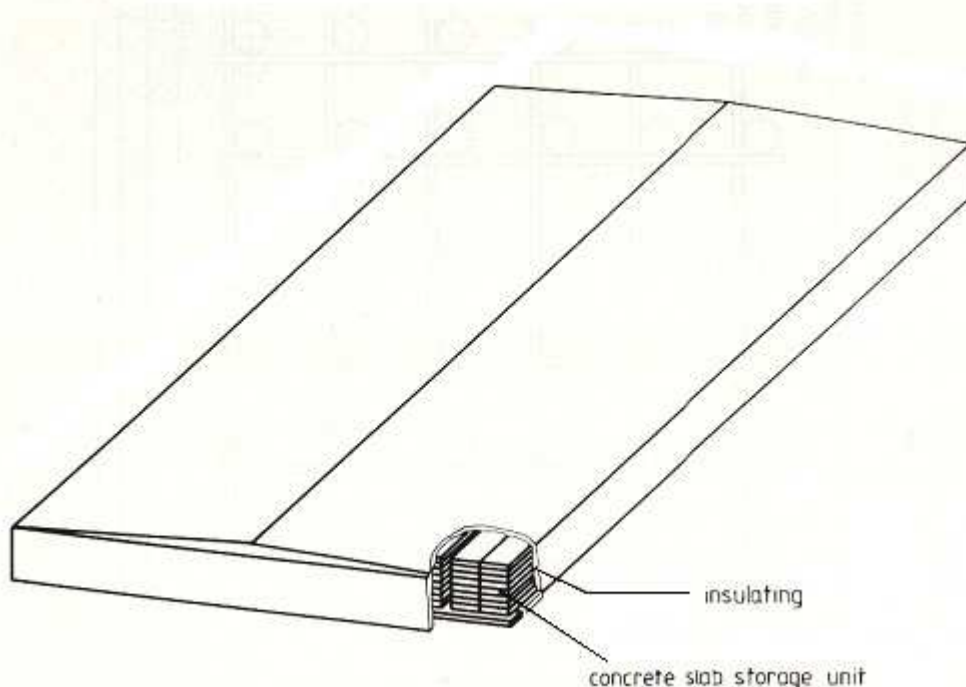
Dispositif d'isolation avec dalle en béton [2]
